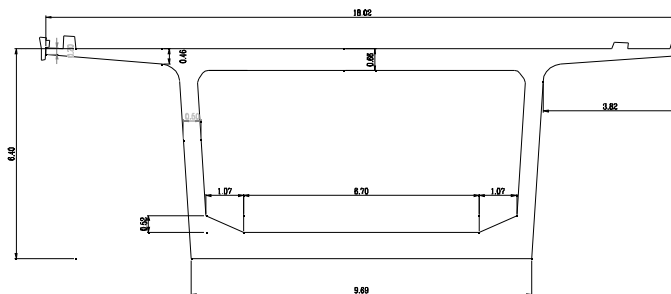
Corte transversal do tabuleiro sobre os pilares P2 e P3.
